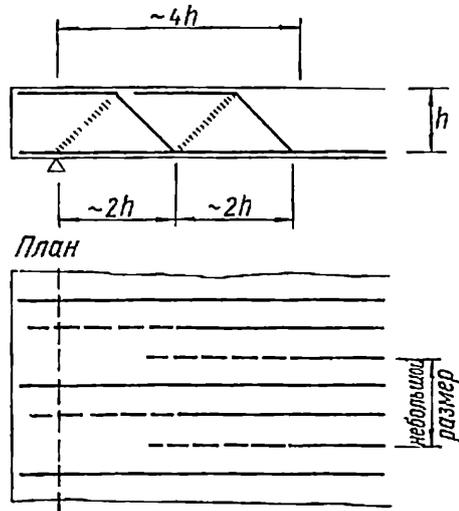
I - I2. Охватывающая арматура по свободным краям плит
